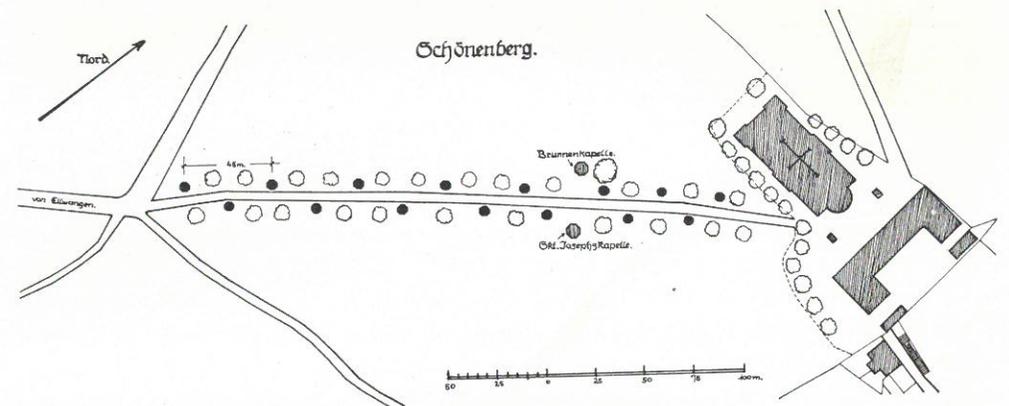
Lageplan des Stationswegs auf den Schönenberg bei Ellwangen.
